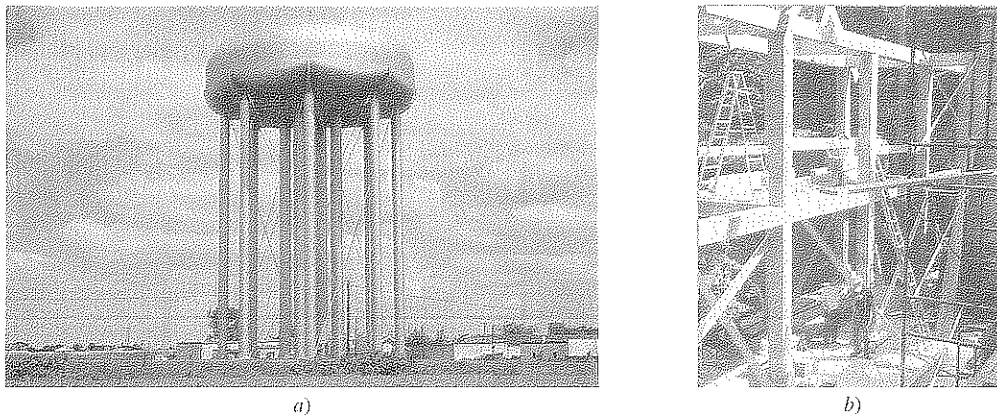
El tanque de agua a) se apoya en columnas de acero, y el edificio en construcción b) se estructura con columnas de madera.
